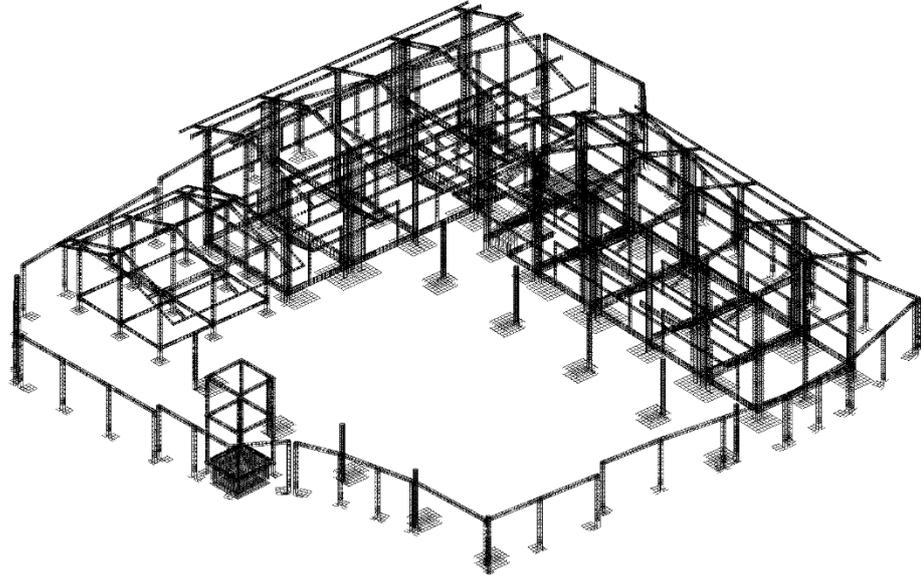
Categoría Armadura Estructural aislada del modelo federado de Estructuras
